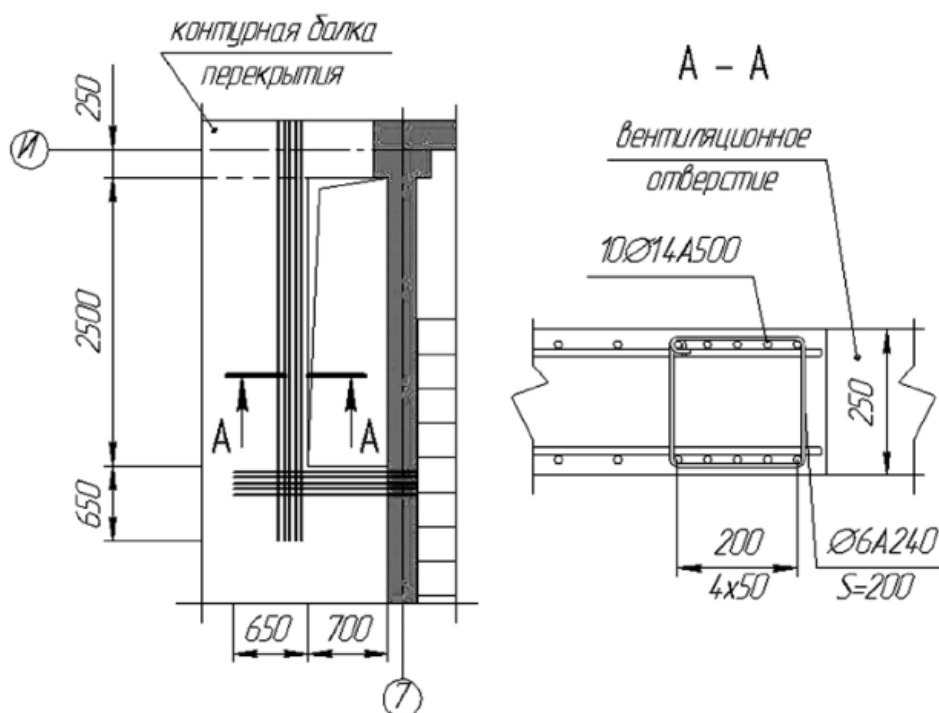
Пример армирования периметра отверстия в перекрытии предназначенного под вентиляционную шахту
